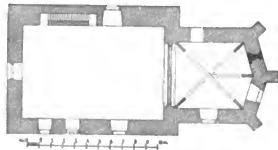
Lašowitz. Grundriss der Kirche.
